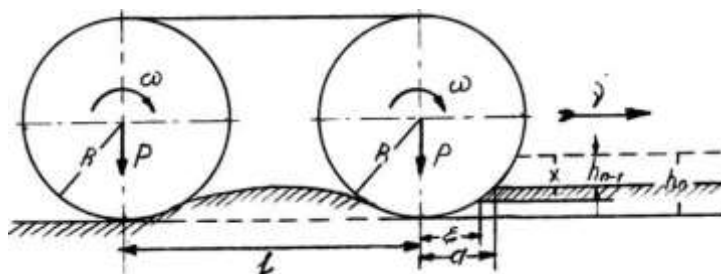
Металлическая гусеница двухосного колесного движителя
